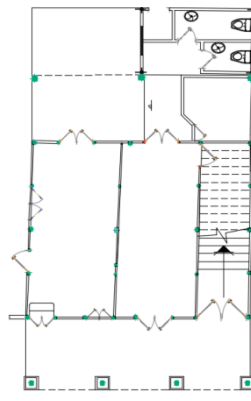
Plano de planta baja de la Casa Cevallos Arizaga. (INPC, 2017)
